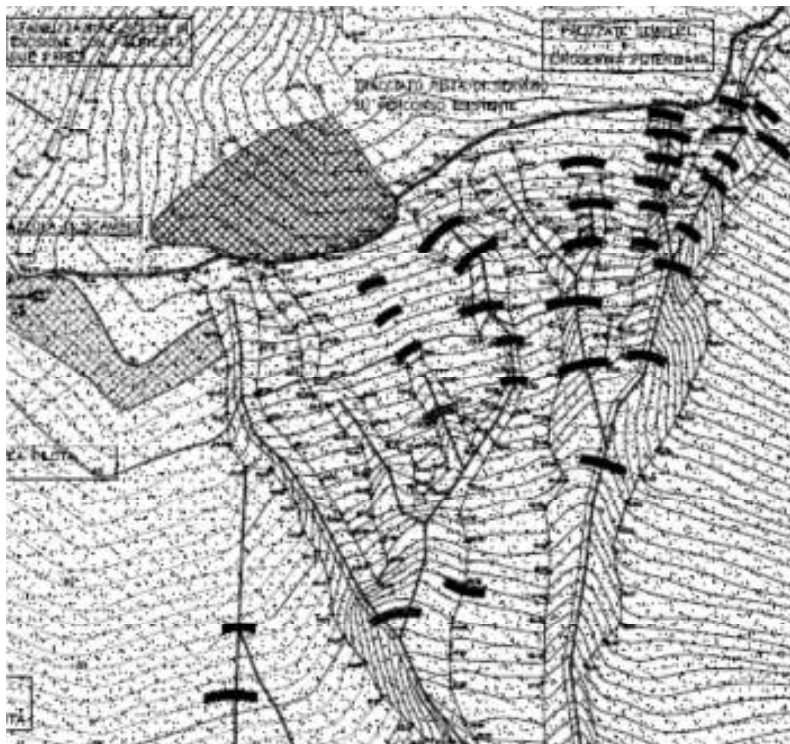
Stralcio di planimetria degli interventi (as built), zona dei calanchi, loc. Tosse.
